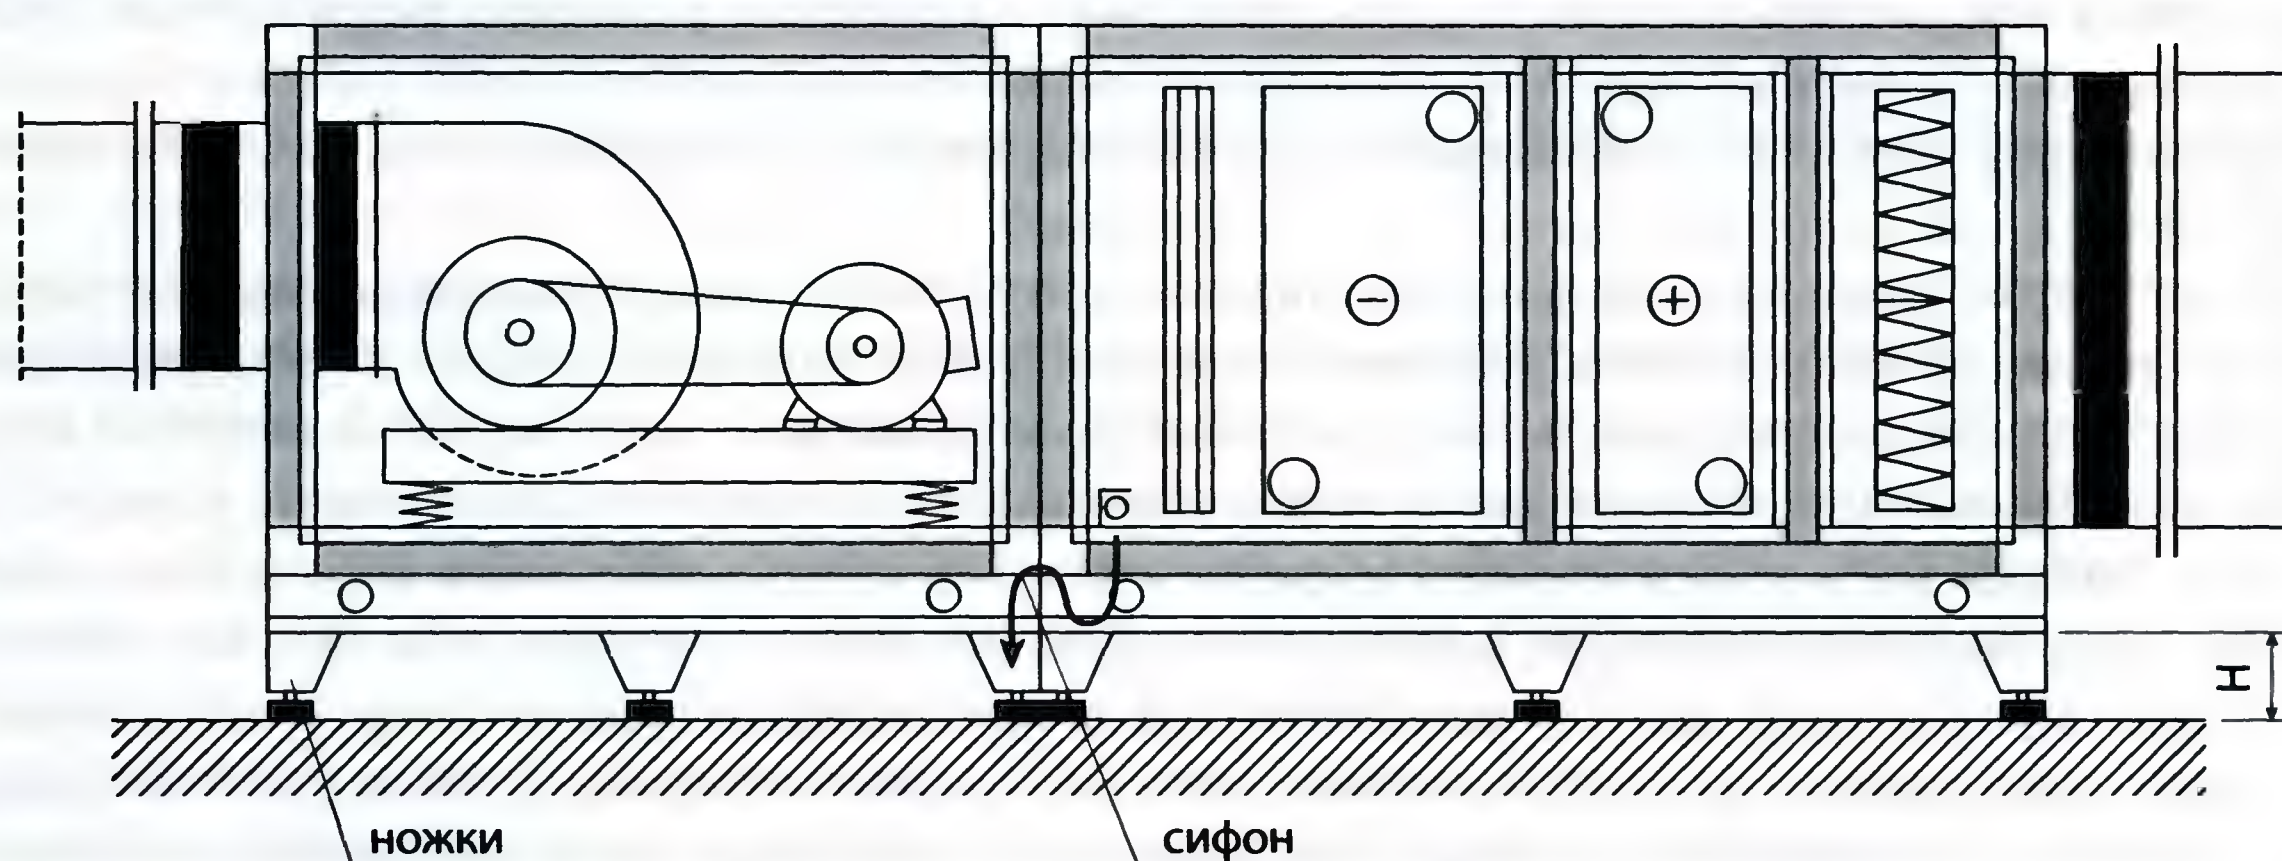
Установка центрального кондиционера на ножках с регулирующими винтами и резиновыми амортизаторами
